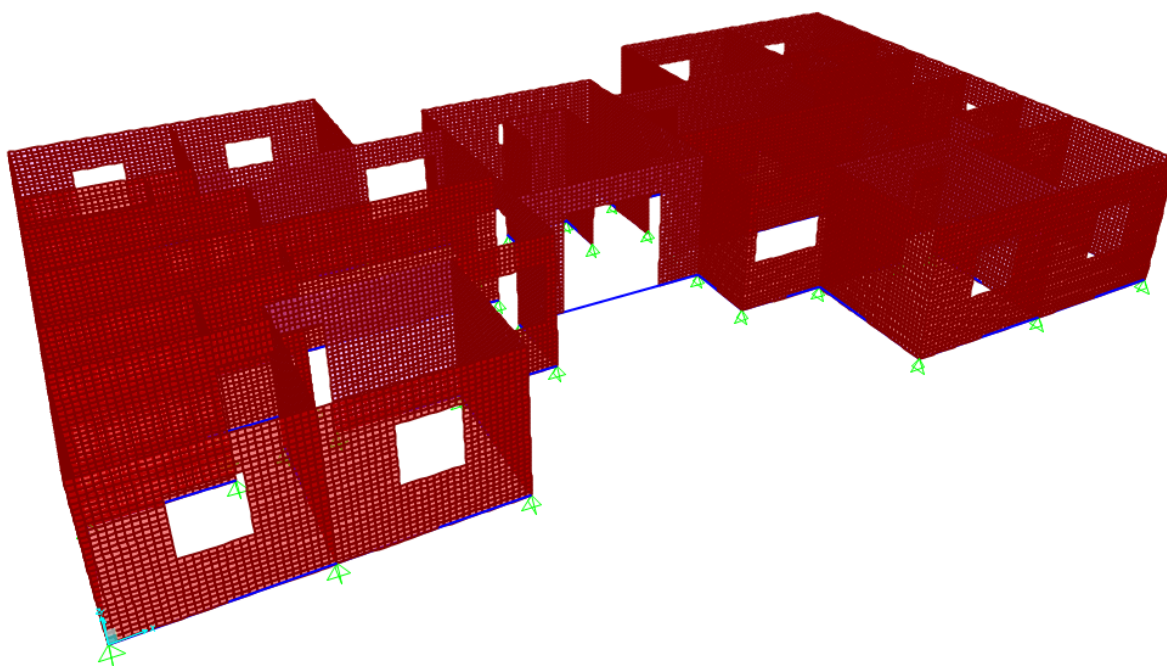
Estrutura com as paredes discretizadas no Sap2000. – Elaborado pelo autor
